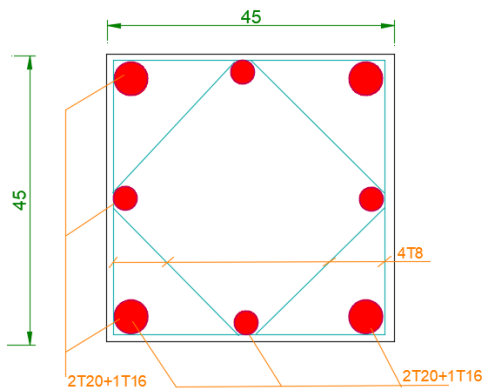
Schéma De Ferrailage Des Poteaux de 9^{eme} étage.
